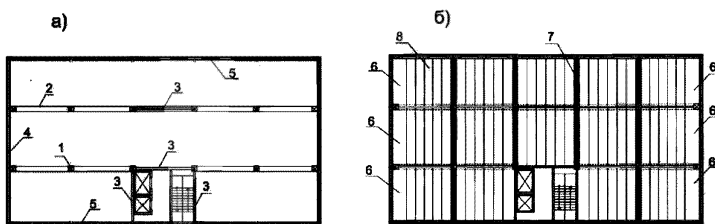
Каркасно-стеновая система: 1 – колонны; 2 – ригели; 3 – диафрагмы жесткости; 4 – торцевые наружные стены; 5 – наружные стены фасада; 6 – перекрытия опиранием по трем сторонам; 7 – связевые балки (плиты); 8 – рядовые плиты опиранием на две стороны
